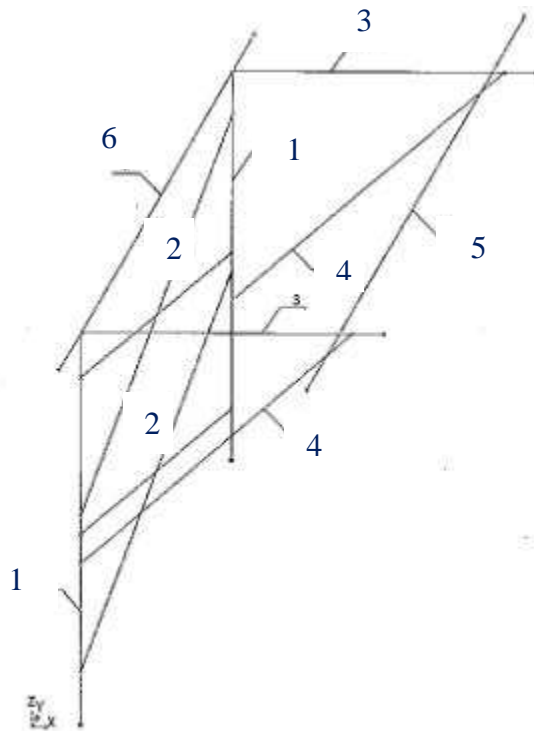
Габаритные размеры двухопорной металлоконструкции
